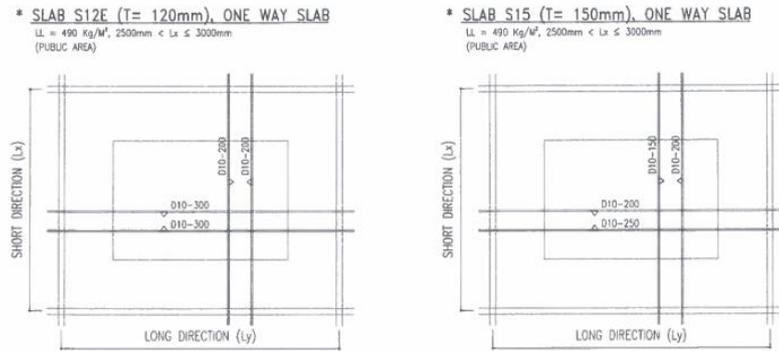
6 Denah penulangan pelat lantai dasar EKA HOSPITAL BSD
